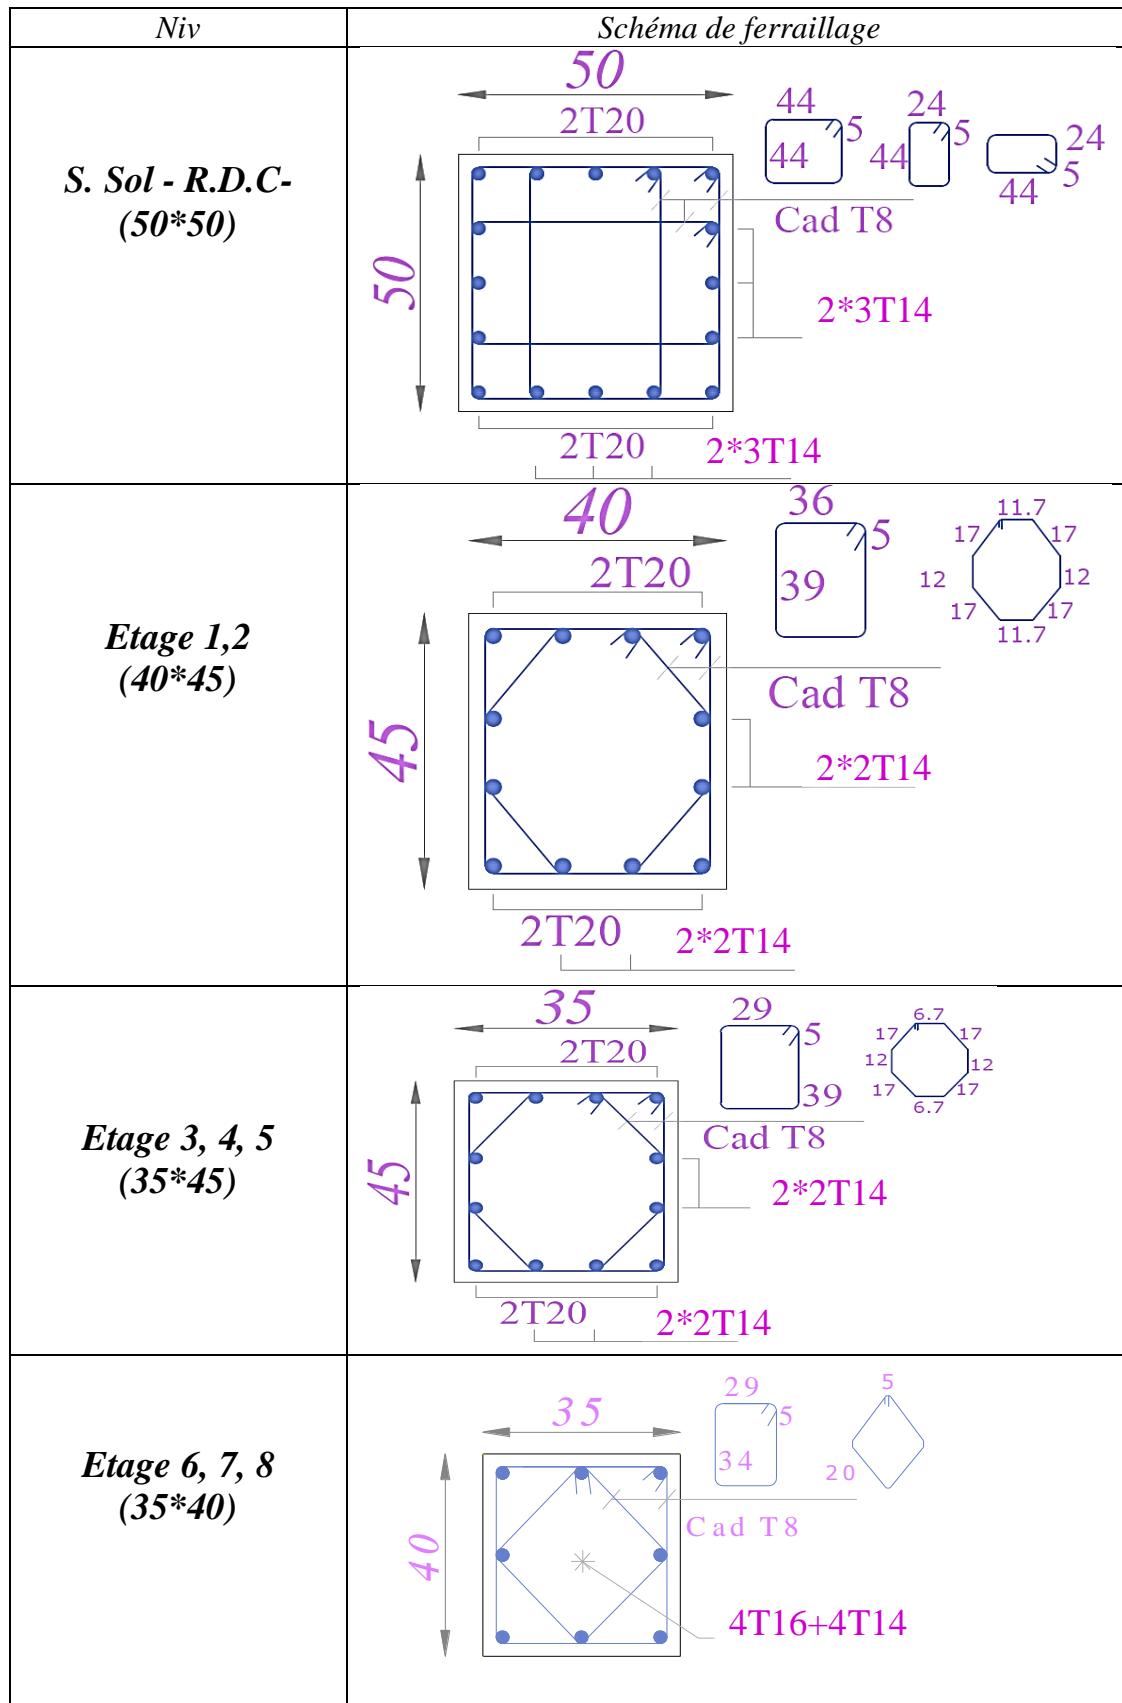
Ferrailage des poteaux (Vue en plan)
